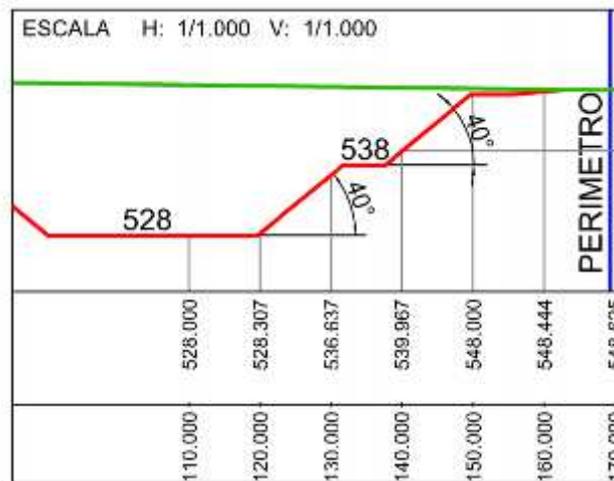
Detalle de perfil longitudinal 7-7' tomado del plano nº 8 *Perfiles* del Plan de Restauración de la cantera "Las Nieves I".
